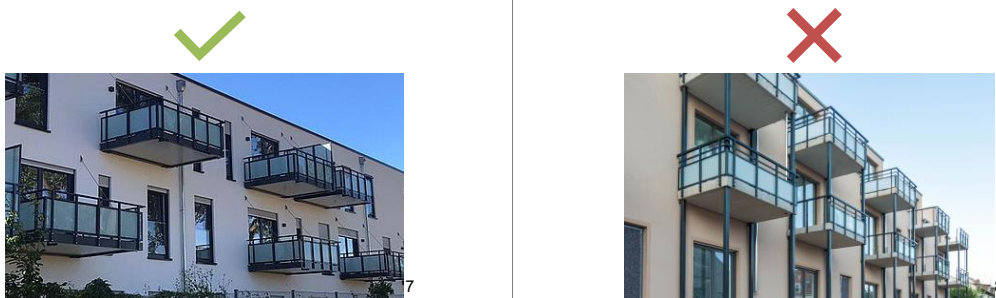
Erklärende Beispiele zur Art der Balkonkonstruktion
